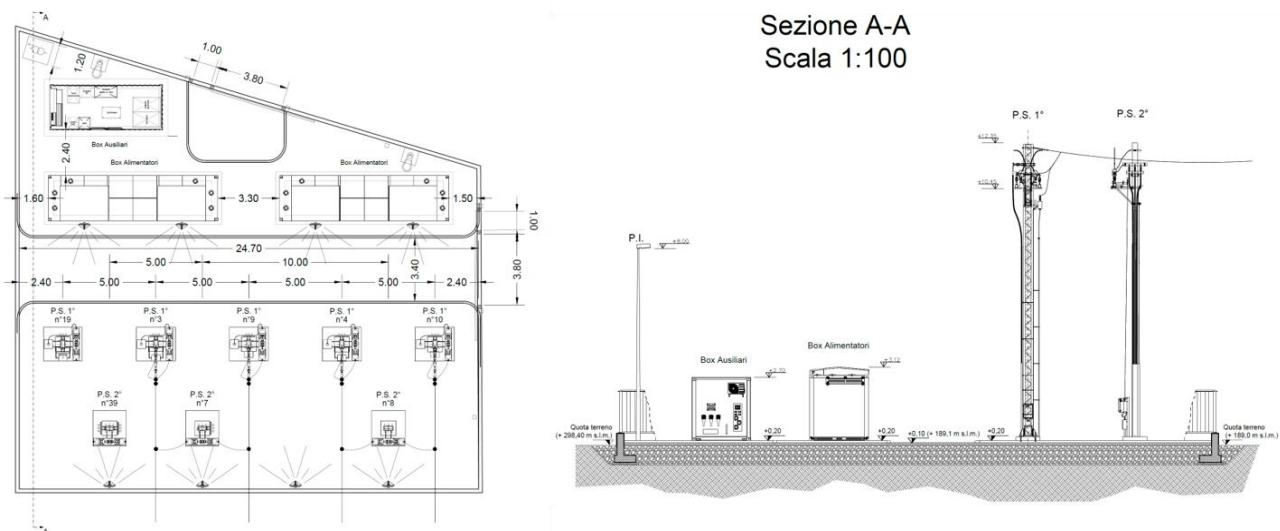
CTE Trento – Planimetria e sezione di piazzale con layout delle apparecchiature
